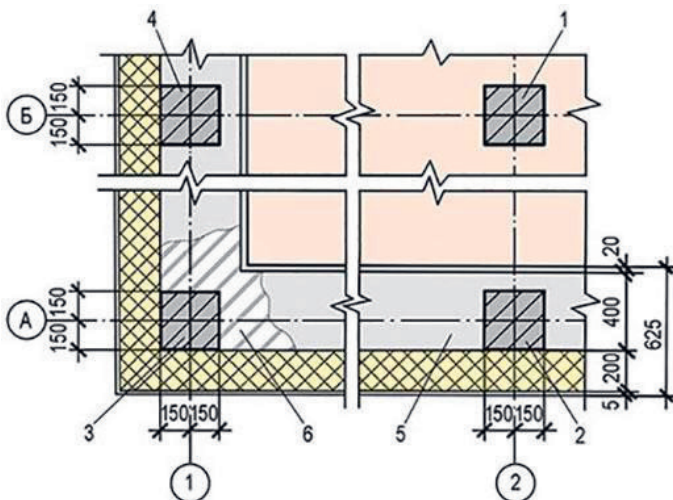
Фрагмент плана этажа малоэтажного гражданского здания с монолитным железобетонным каркасом и 2-слойными наружными стенами с эффективной теплоизоляцией; 1 – рядовая колонна среднего ряда; 2 – рядовая колонна крайнего ряда; 3 – торцевая колонна крайнего ряда; 4 – торцевая колонна среднего ряда; 5 и 6 – кладка из ячеистобетонных блоков, показанная для сравнения по-дизайнерски и по правилам строительного черчения
